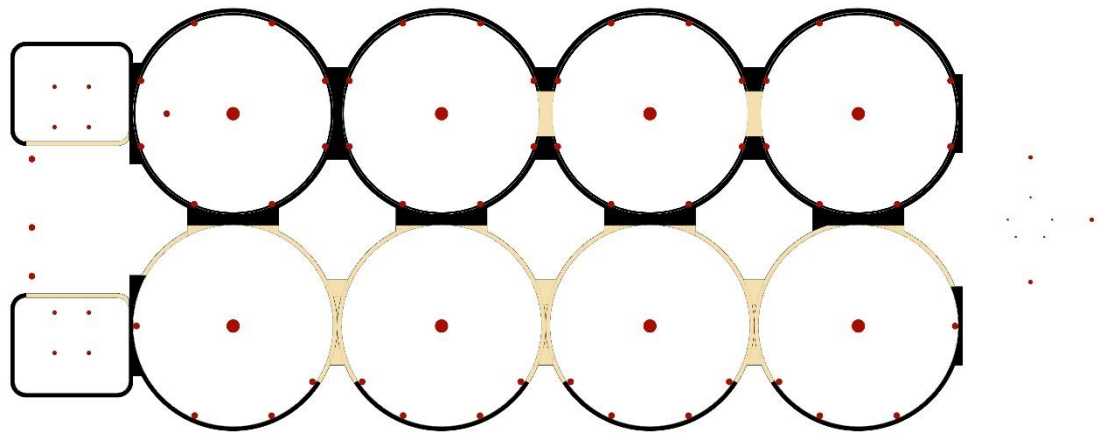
Plan der Neue Skelet Trägerkonstruktion (rot) mit dem Abbruch der bestehenden Wänden (gelb).
